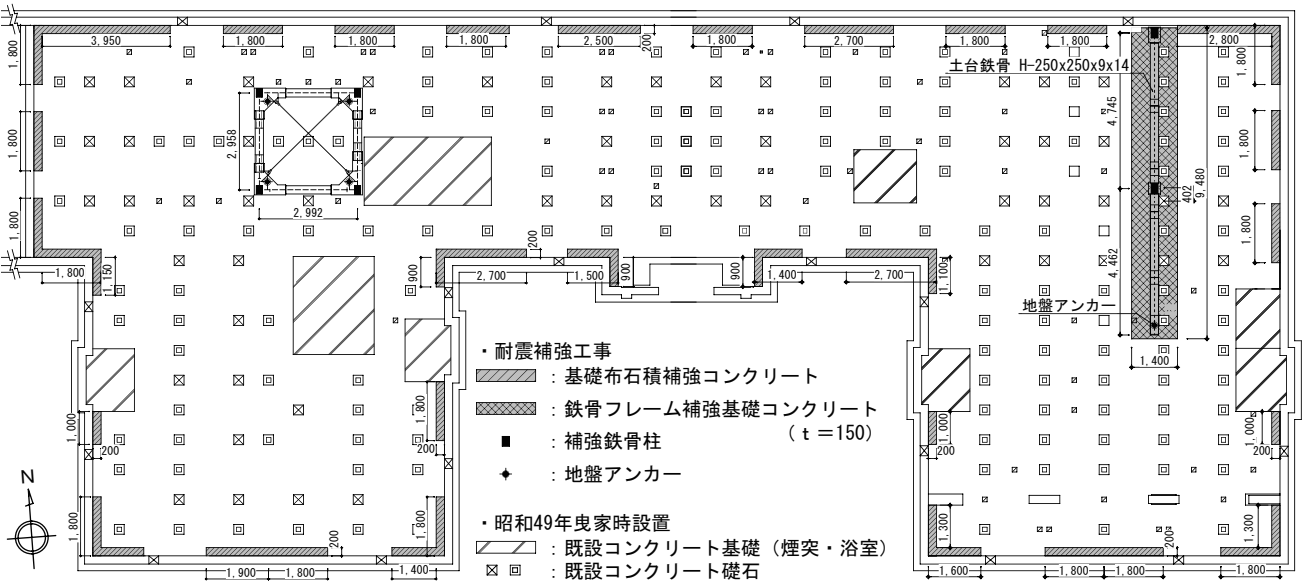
基礎布石積補強及び鉄骨フレーム補強基礎平面図
